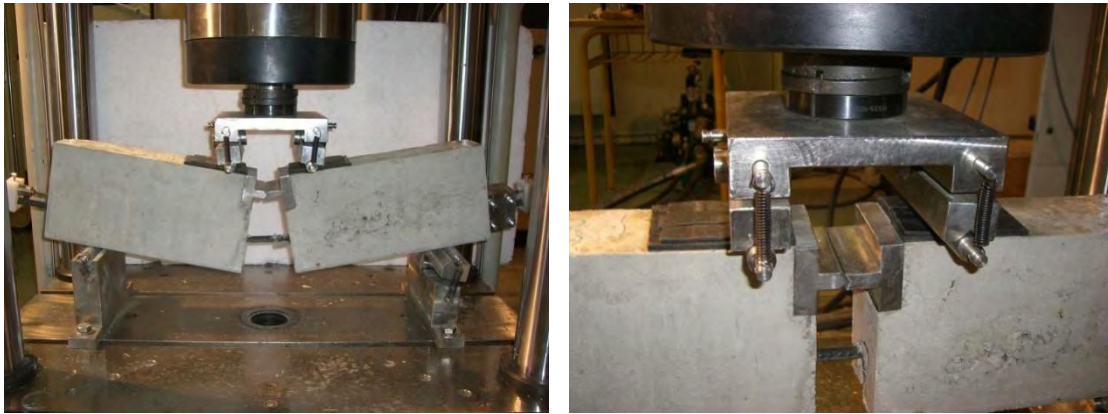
Detalle de la chapa metálica y neopreno del ensayo de adherencia.
